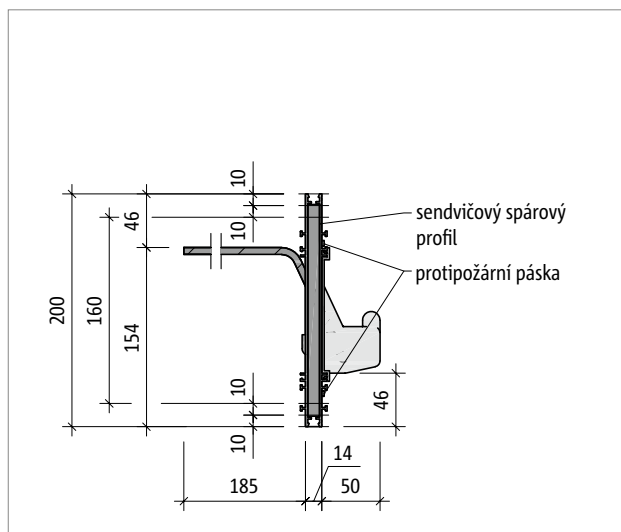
Schöck Tronsole® typ T: Uspořádání prvků – detail B
